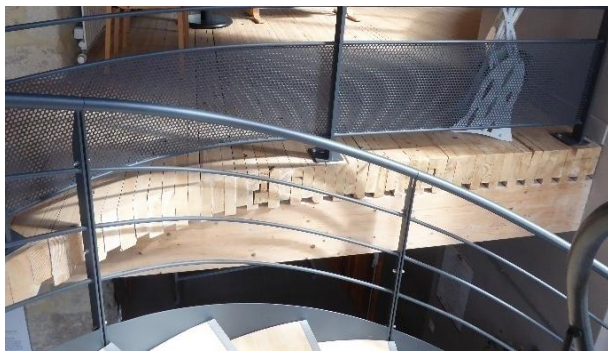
Plancher autoportant de l'étage – Les lames décalées piègent les sons dans la salle de réunion au rez-de-chaussée
